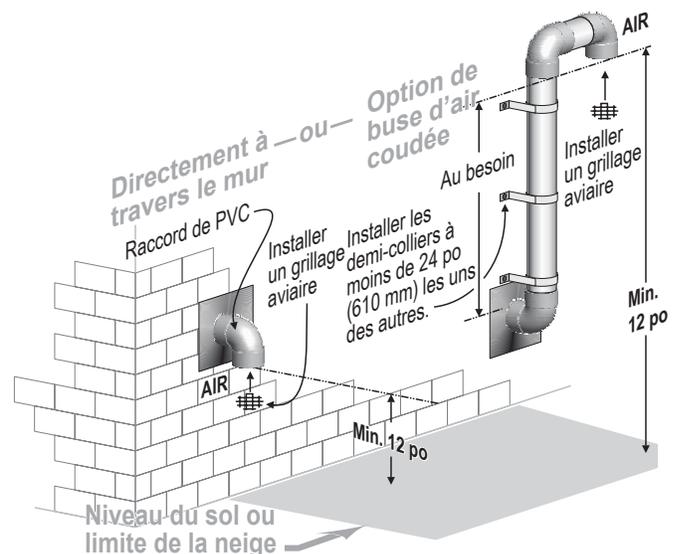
Entrée d'air sur mur latéral (terminaison) pour ventilation directe : tuyau d'évent vertical/tuyau d'air sur mur latéral
